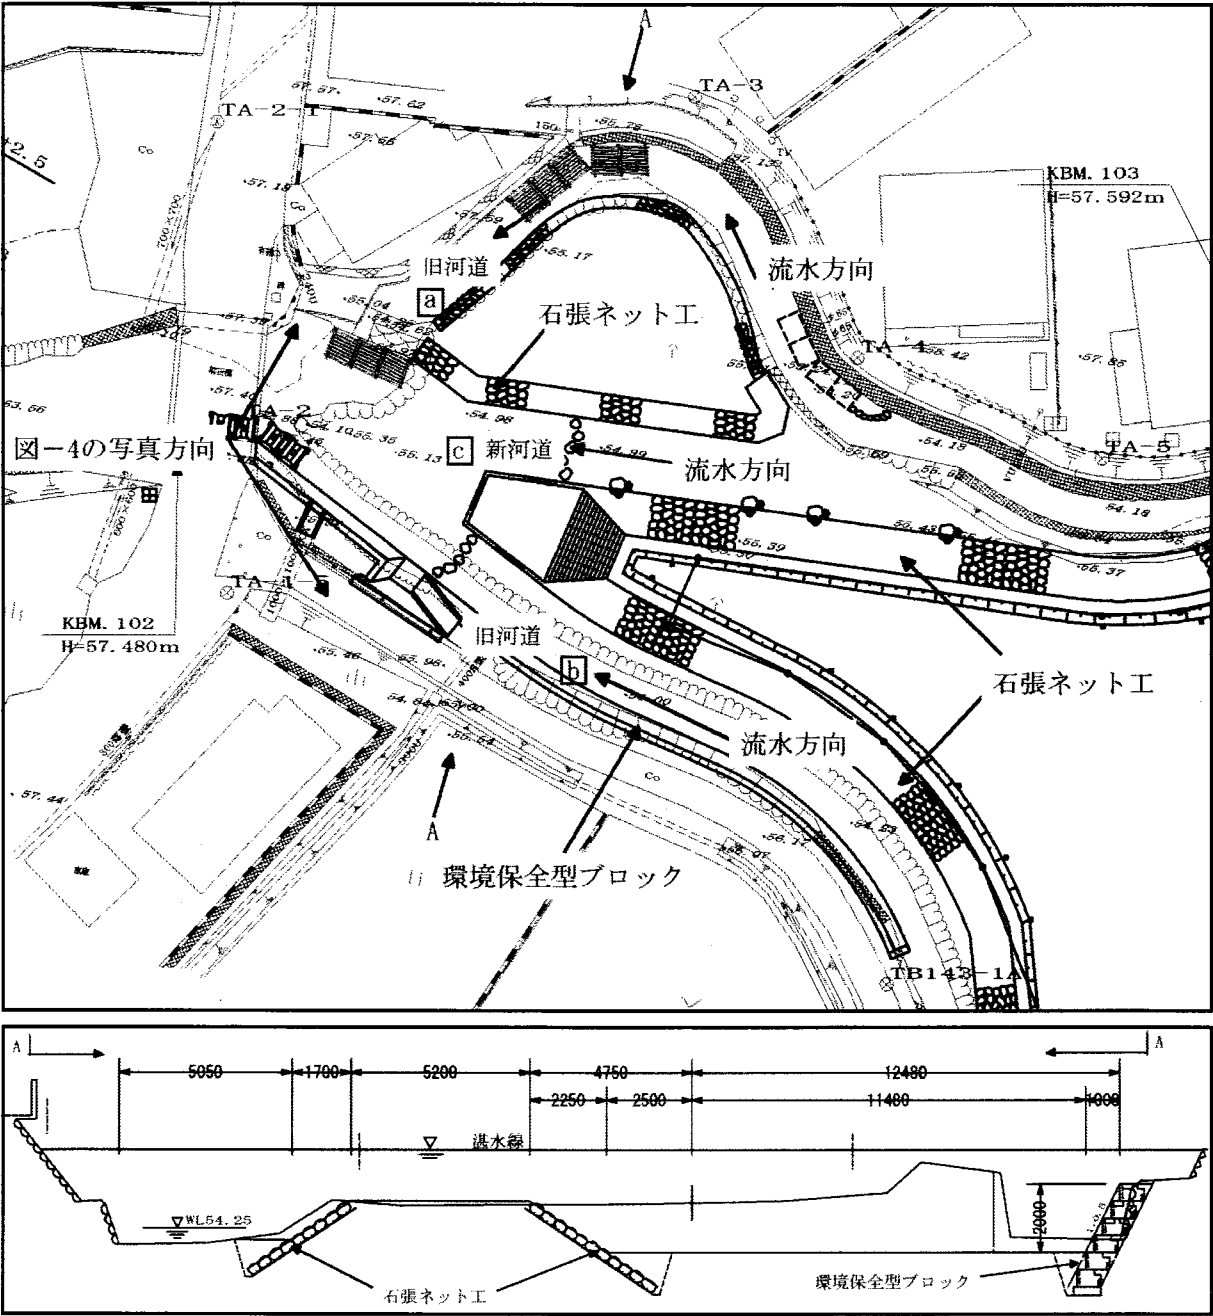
皆田地区での環境配慮工法の平面図（上）と横断図（下）
